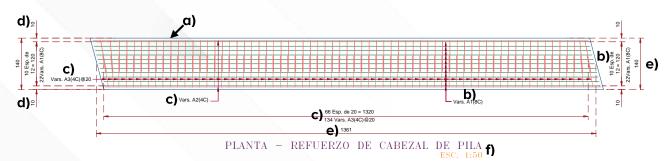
Ejemplo planta de refuerzo de cabezal de pila
